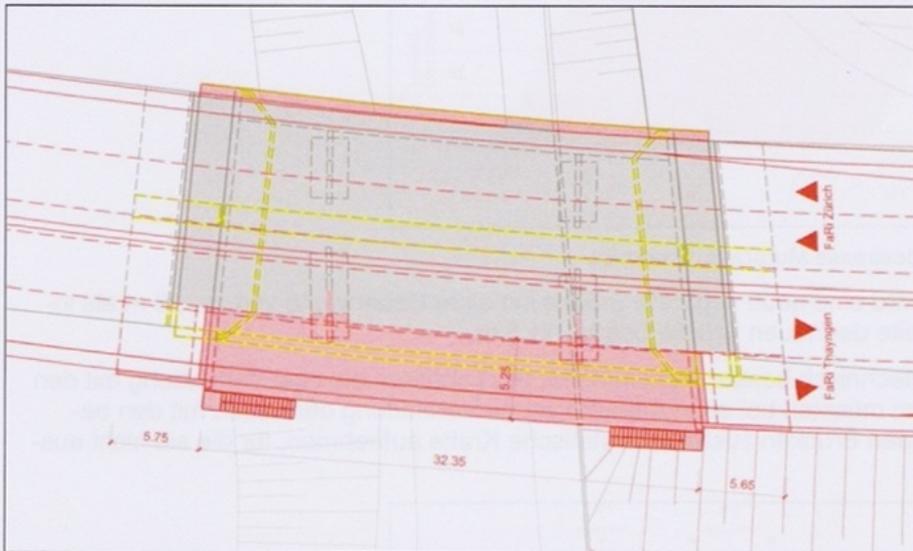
Brücke über Gennersbrunnerstrasse, Grundriss
